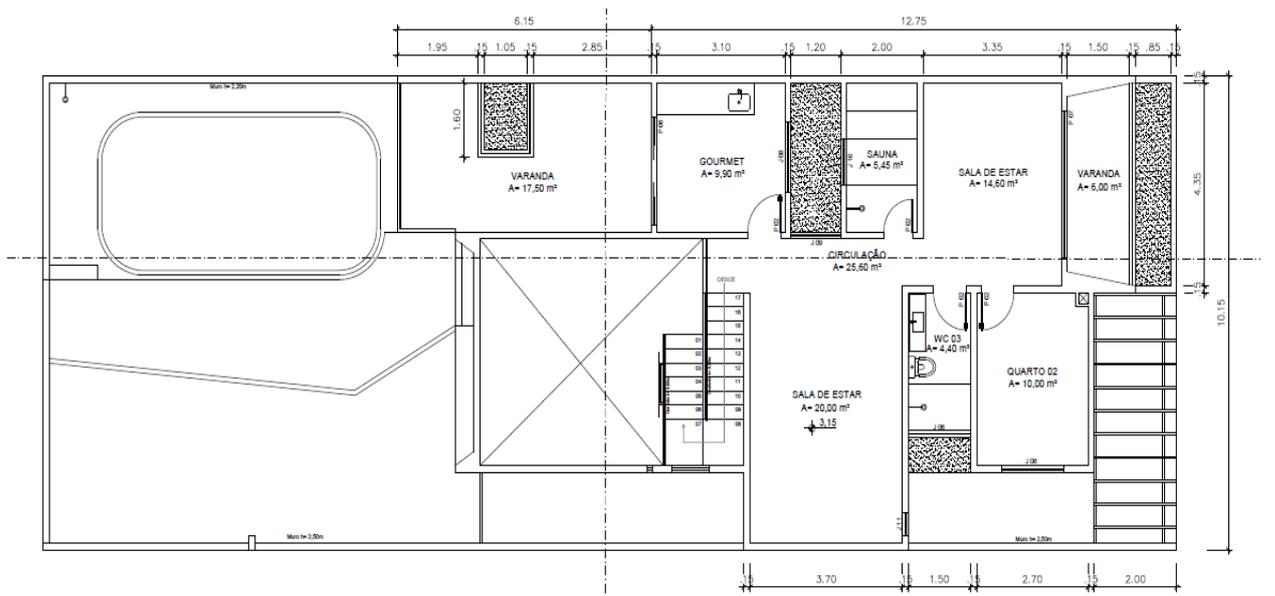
Planta baixa do Pavimento Superior (ADAPTADO DO PROJETO ORIGINAL, 2018).
